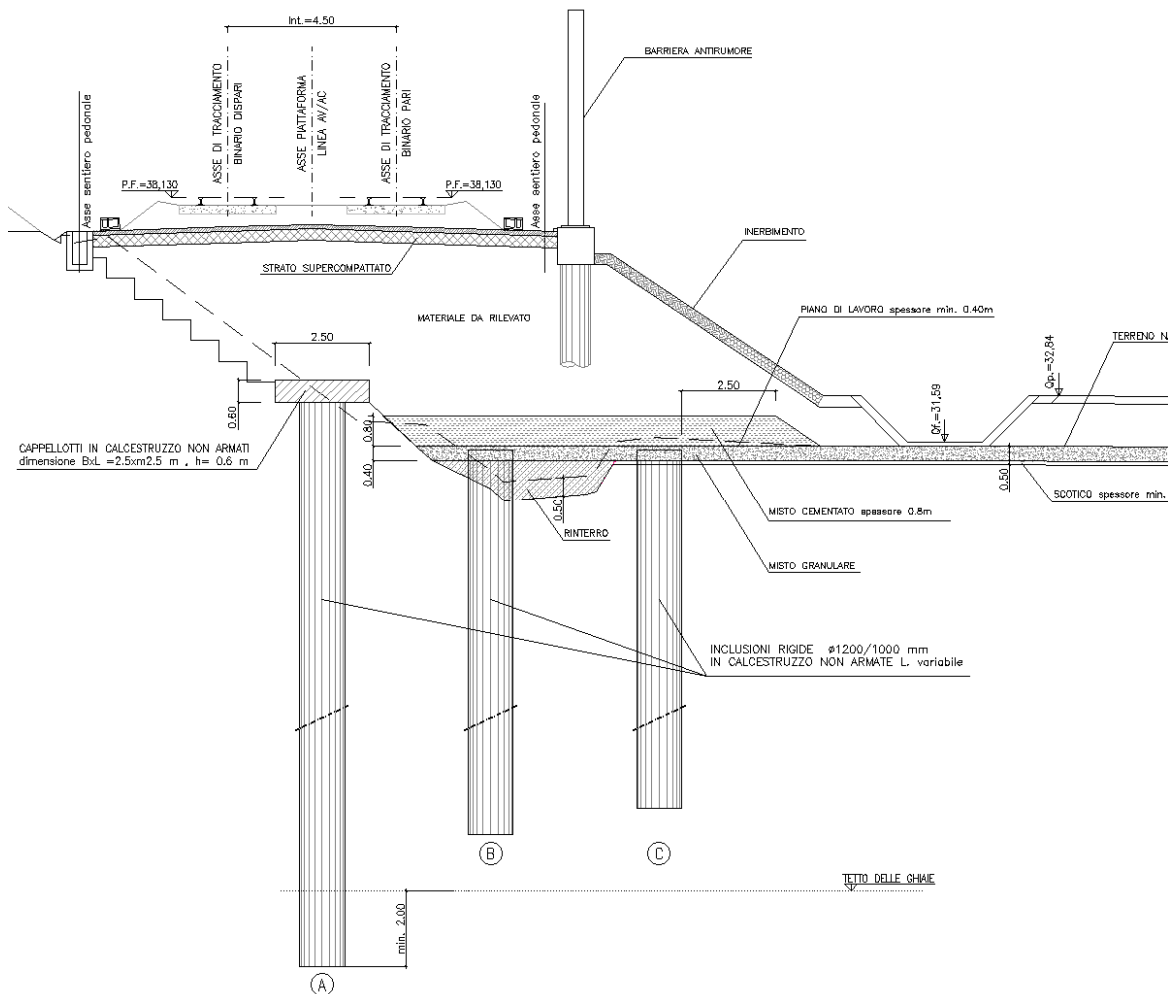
Progetto Esecutivo - sezione di intervento Ri60
